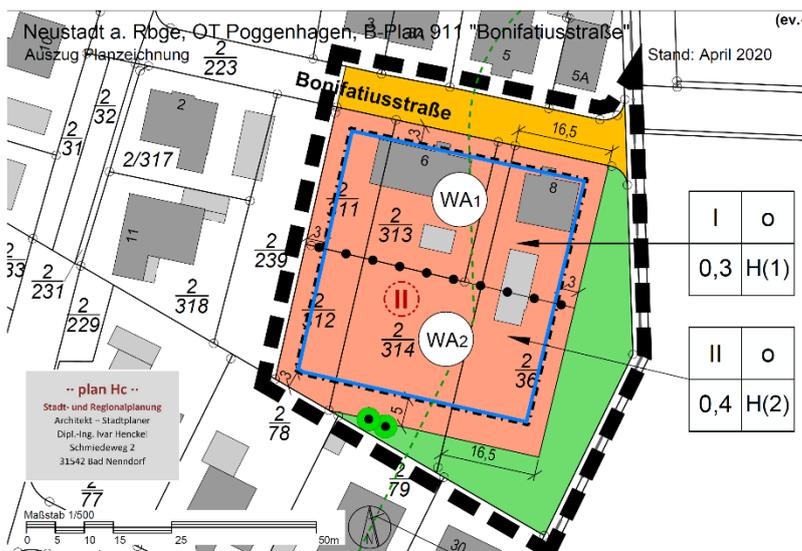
Bebauungsplan Nr. 911 „Bonifatiusstraße“ (Planentwurf und Lageplan und, Quelle: plan Hc, Stadt und Regionalplanung, Stand: Februar 2020)
